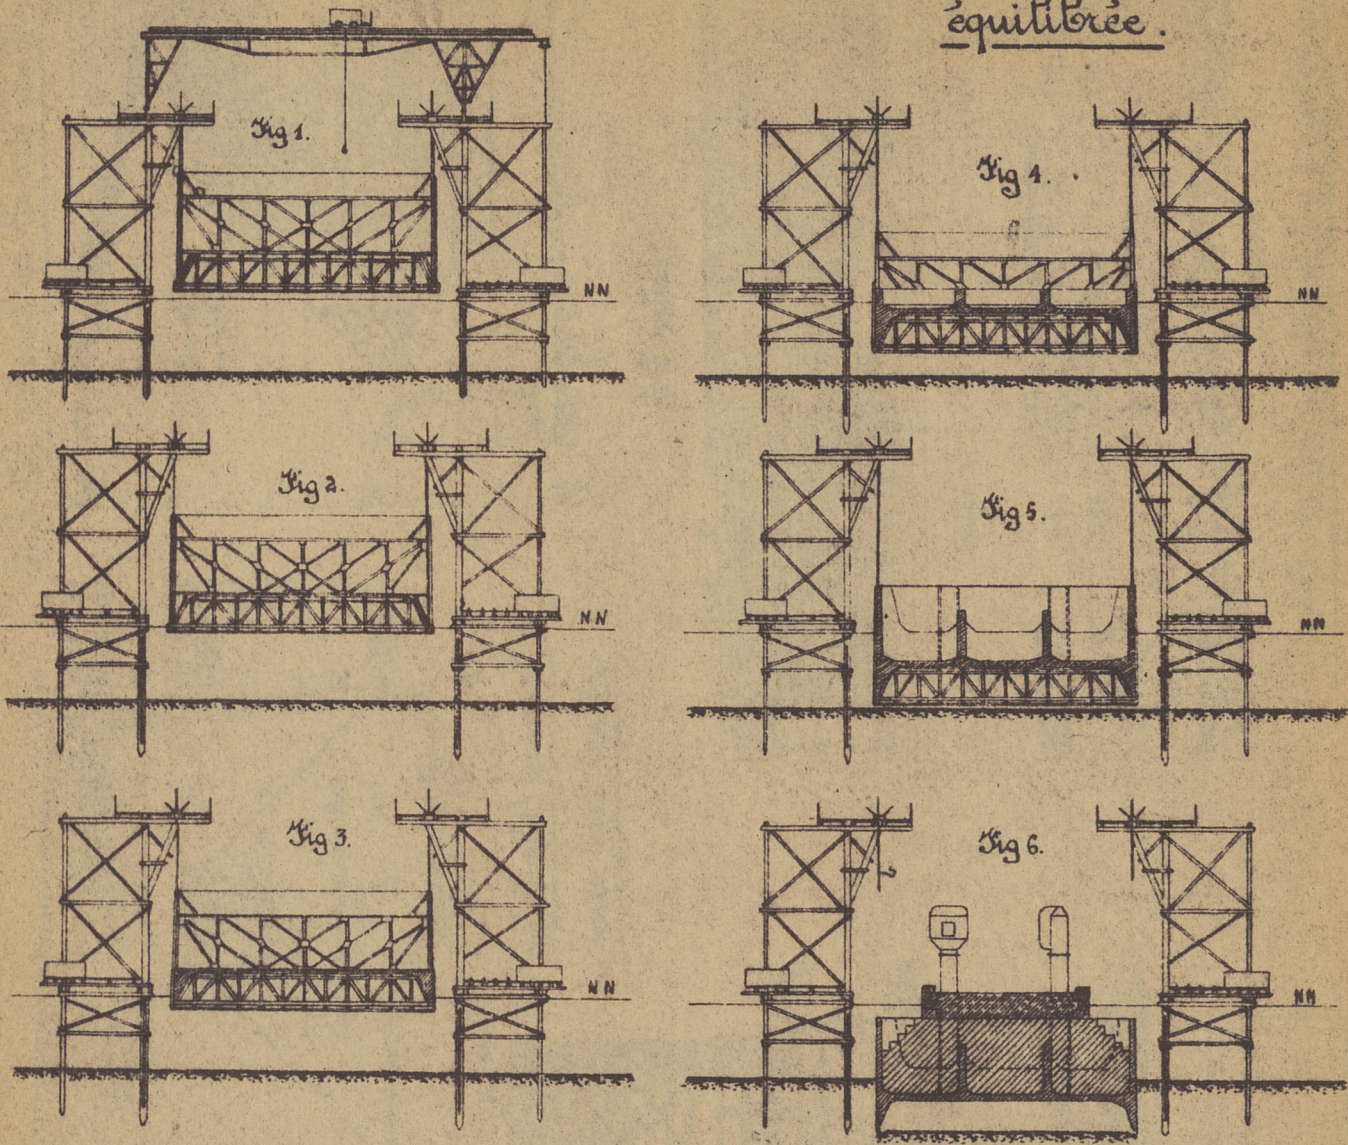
Montage d'un caisson sur échafaudage fixe.
